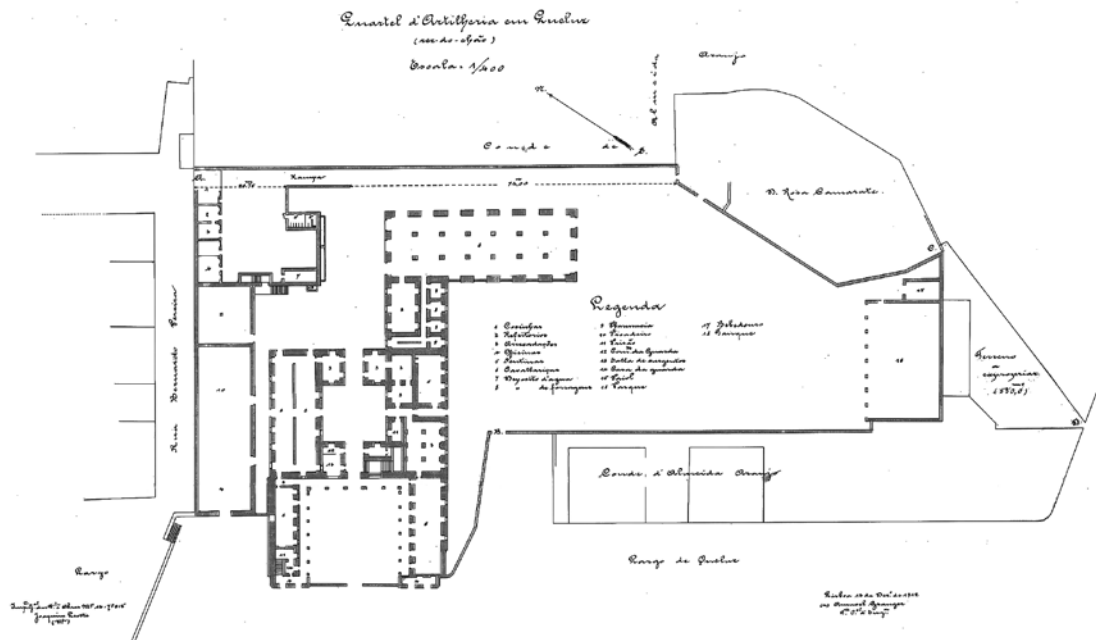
Planta do Quartel d'Artilharia em Queluz, escala 1/400, 13 de dezembro de 1912.⁴¹
